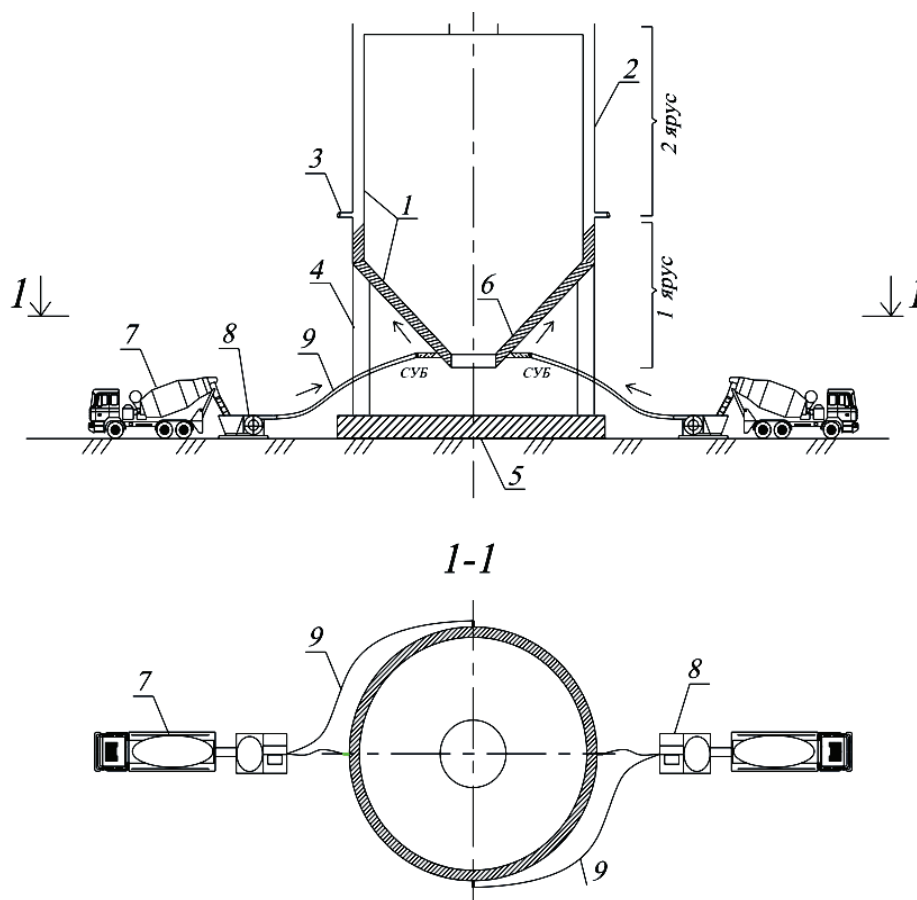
Бетонирование 1-го яруса бункера: 1 – внутренняя опалубка; 2 – наружная опалубка; 3 – штуцеры для подачи бетона; 4 – колонны; 5 – фундамент; 6 – самоуплотняющийся бетон 1-го яруса; 7 – автобетоносмеситель; 8 – роторный насос; 9 – шланг для подачи бетона.
